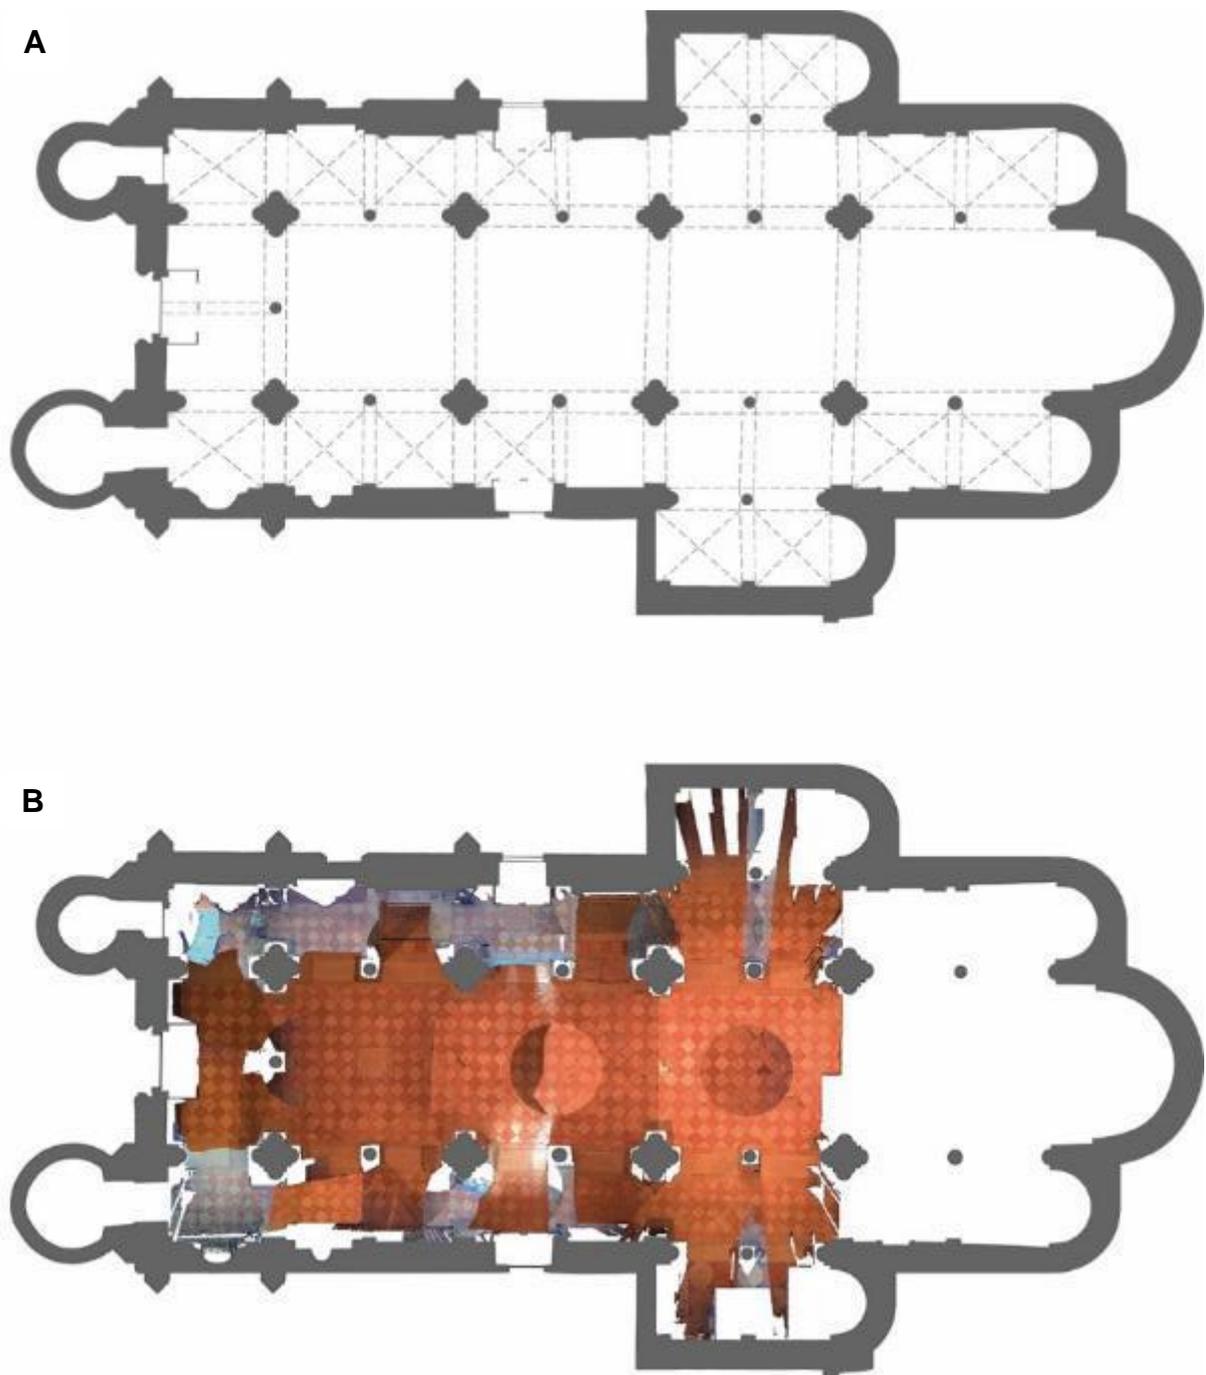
Piante della chiesa con la proiezione delle volte (A) e fotopiano del pavimento (B)
